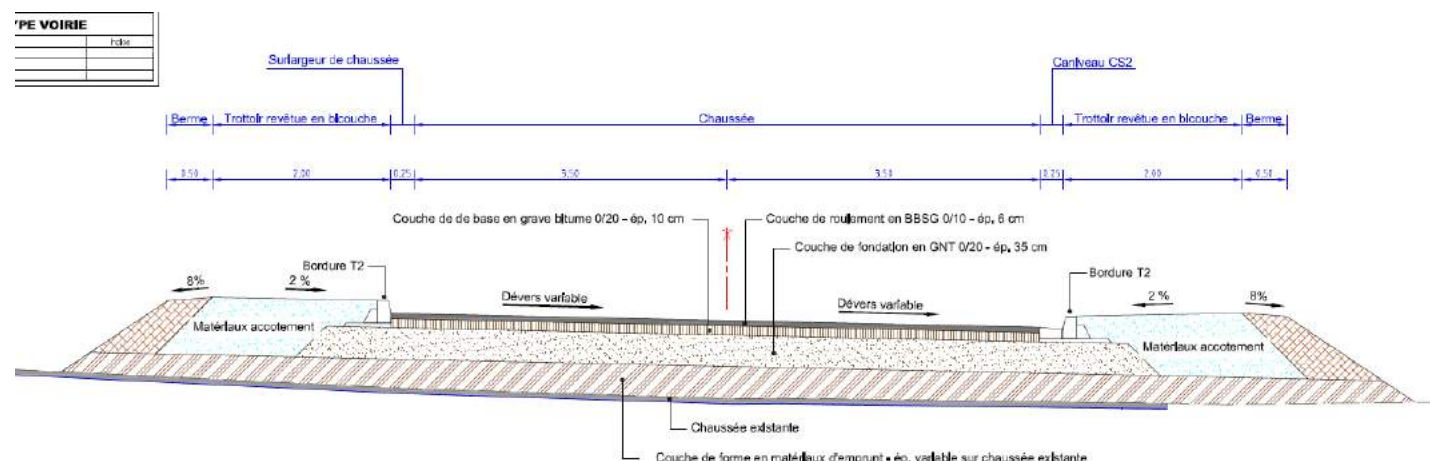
Coupe type sur l'ouvrage entre les culées C0 et C1
